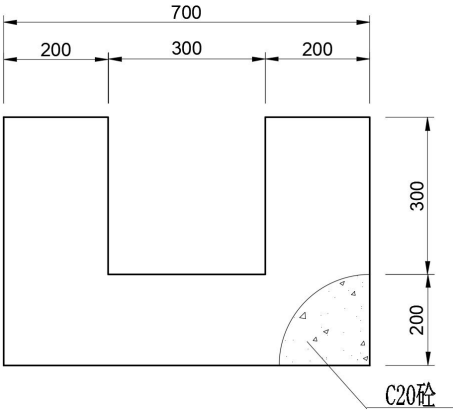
HP01 截排水沟设计断面图（单位 mm）
